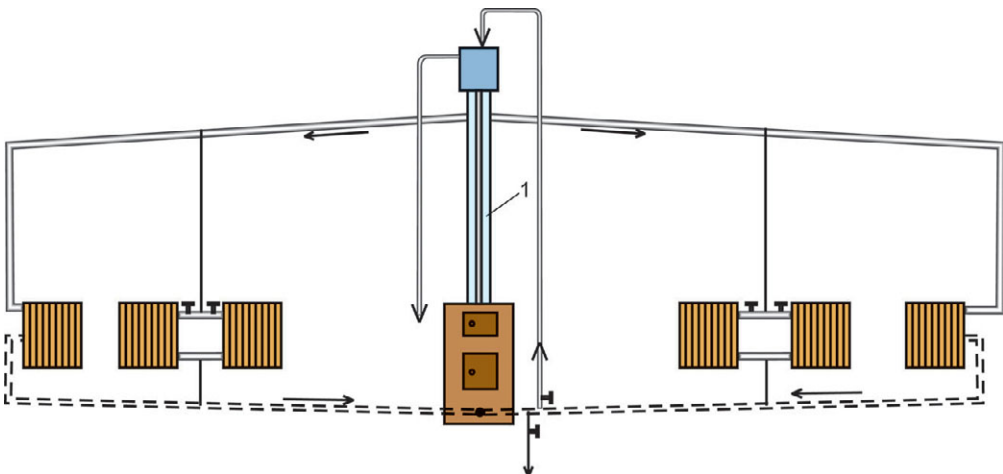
Изоляция главного стояка: 1 — теплоизоляционный слой
